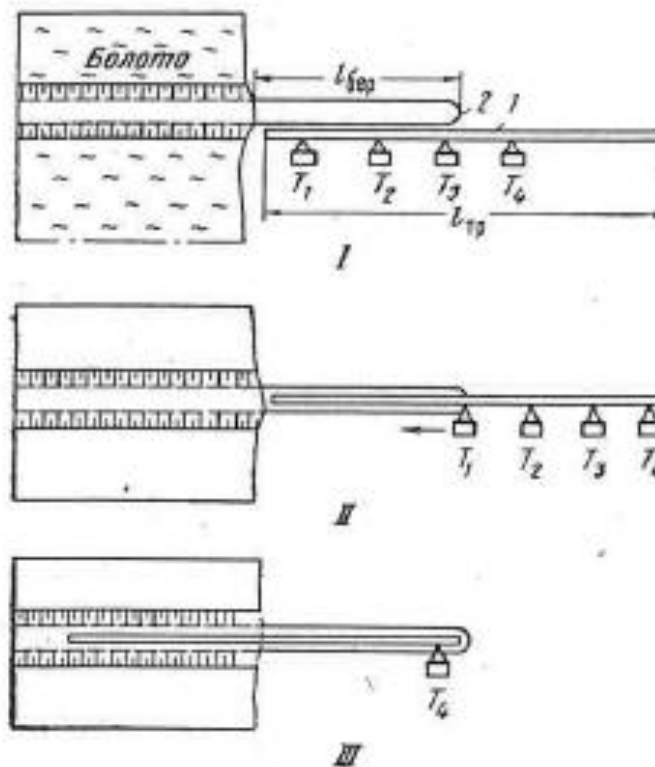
Схема укладки трубопровода сплавом (вариант 1)
